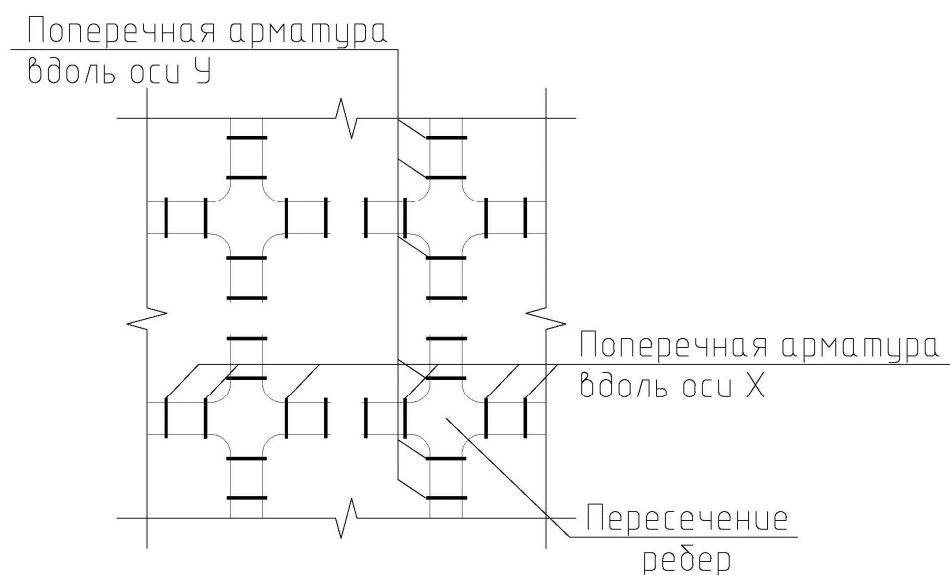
Фрагмент плана расположения поперечной арматуры(хомутов). Хомуты показаны условно. Продольная арматура не показана.
